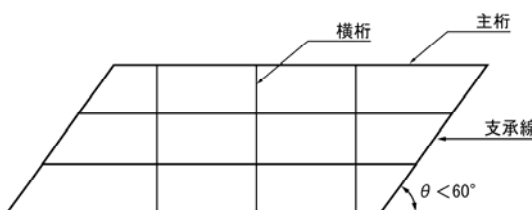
斜角 60° 未満の場合の横桁の配置例
